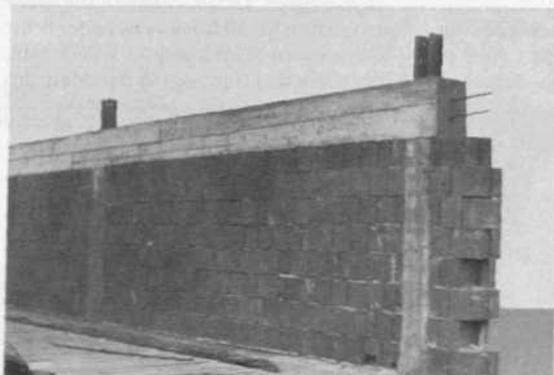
Aussteifung eines Ziegelmauerwerkes mit Stahlbetonstützen und Ringanker
